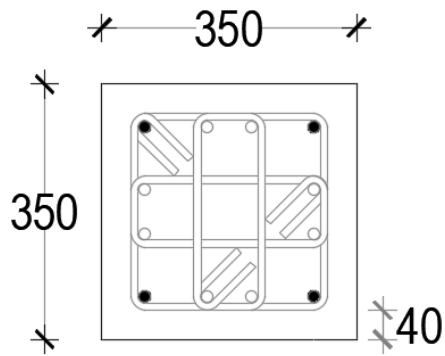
Armado de columnas #1, #2, #3, #4, #5, #6, #7, #8, #9 y #10 de entrespacio y cubierta
